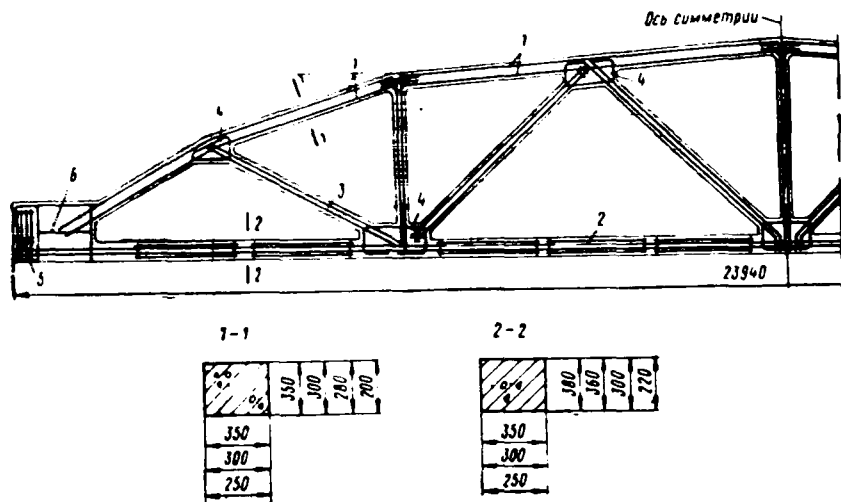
Типовая сегментная ферма пролетом 24 м серии ПК-01-129/68 (каркасы показаны условно без поперечной арматуры, как это принято в последних типовых чертежах)
